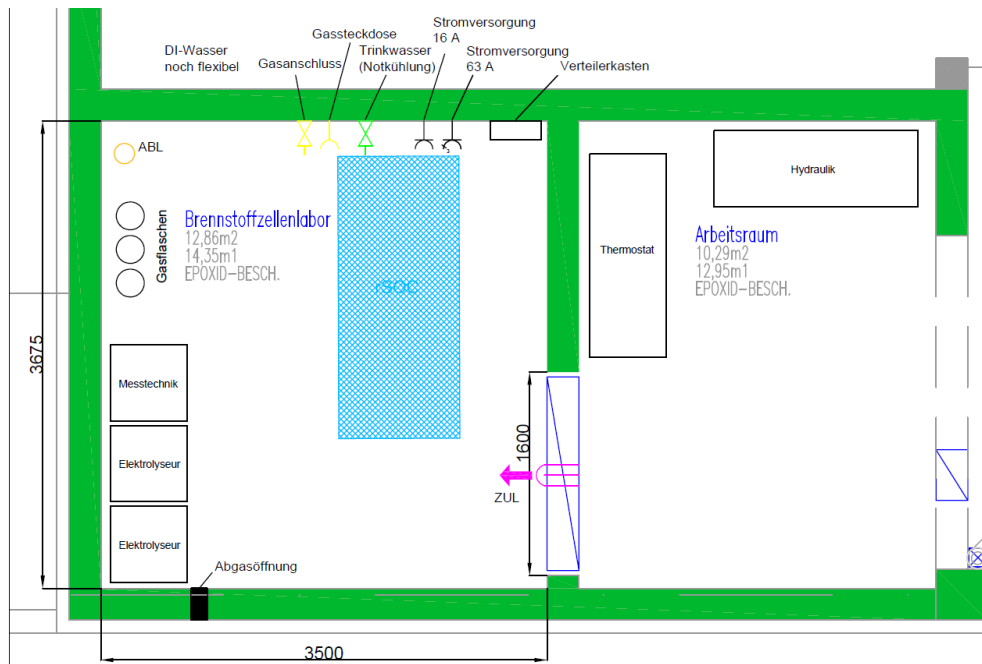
CAD Zeichnung - Aufstellraum im Fuel Cell Labor am Standort Pinkafeld
